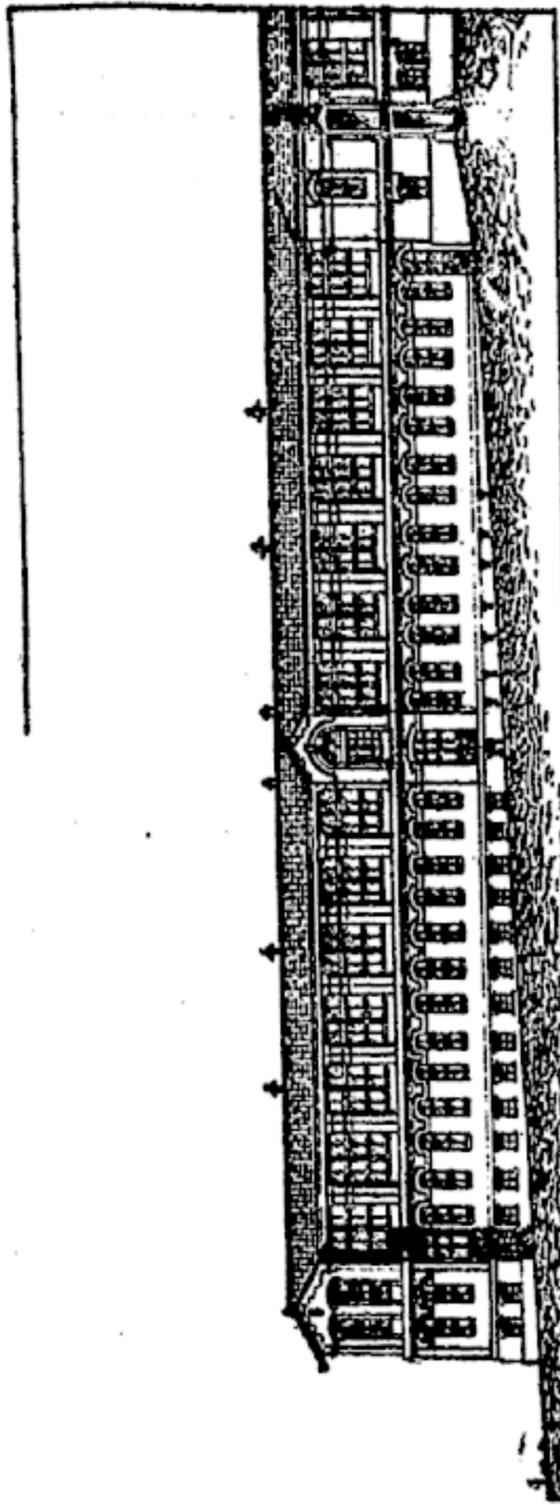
Aspect du dernier bâtiment faisant suite au bâtiment des Ecoles. Le rez-de-chaussée se compose de deux dortoirs de 20 lits chacun et, dans le pavillon nord, d'un logement de sous-employé. Le premier étage est affecté au Musée scolaire, de plain-pied avec les classes, et au Musée anatomo-pathologique. — Dans le sous-sol, à l'extrémité nord, extrémité gauche de la figure, nous avons installé un second service de projeté pour le traitement des tuberculoses.
